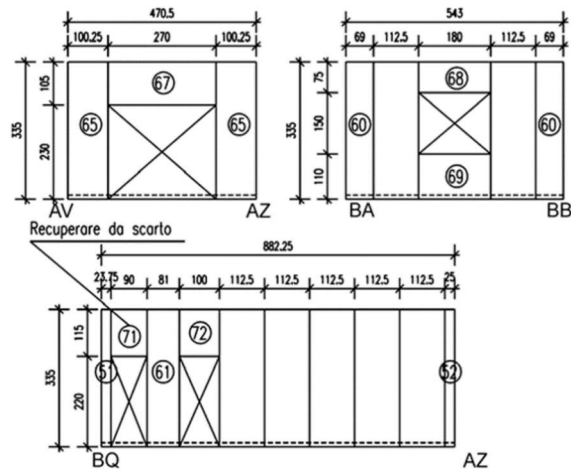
Vista en elevación del diseño de modulación de paredes - Emmedue, 2008.
